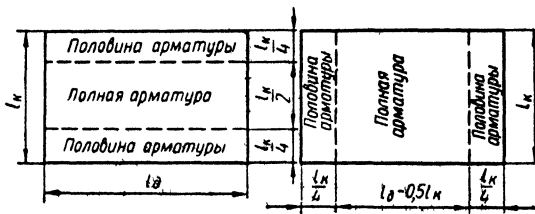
Схема армирования плиты, опертой по контуру.
